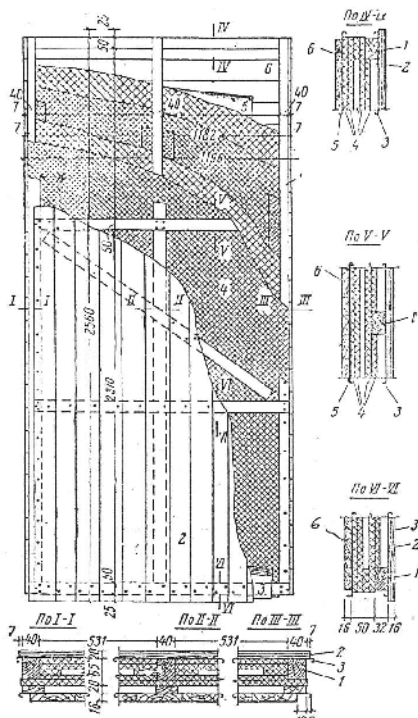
Наружный стеновой дощатый щит: 1 – элементы каркаса щита; 2 – наружная вертикальная дощатая обшивка; 3 – воздухопроницаемый слой (бумага); 4 – четыре слоя плитного утеплителя; 5 – пароизоляция; 6 – внутренняя обшивка
